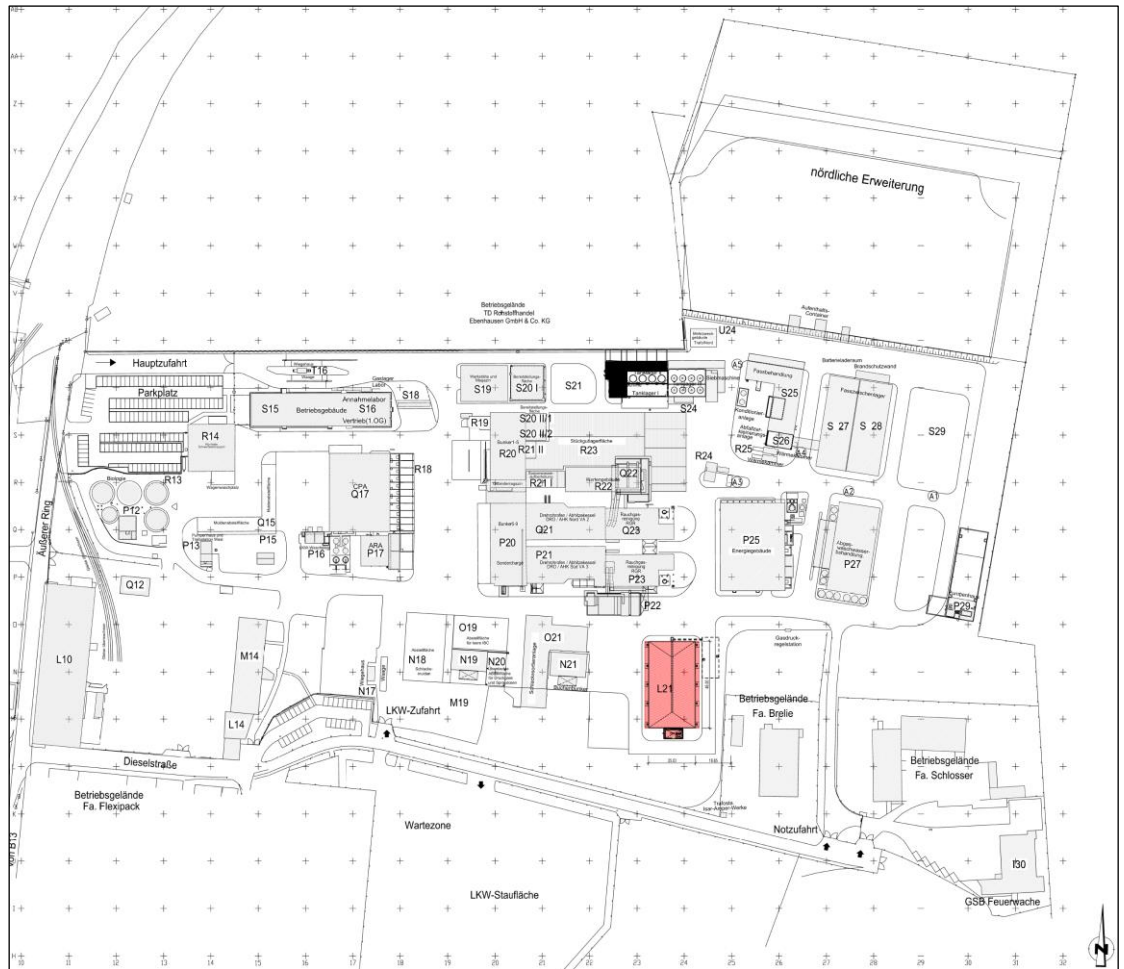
Lageplan der geplanten Stückgutabstellfläche L21 (Quelle: IA-Tech GmbH)
